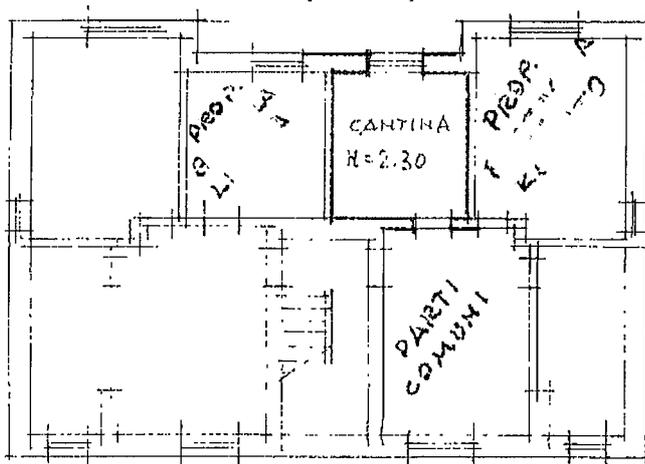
A – Planimetria dell'appartamento e cantina (evidenziato in giallo) sito in via Legnano n. 2, Inveruno(MI).
